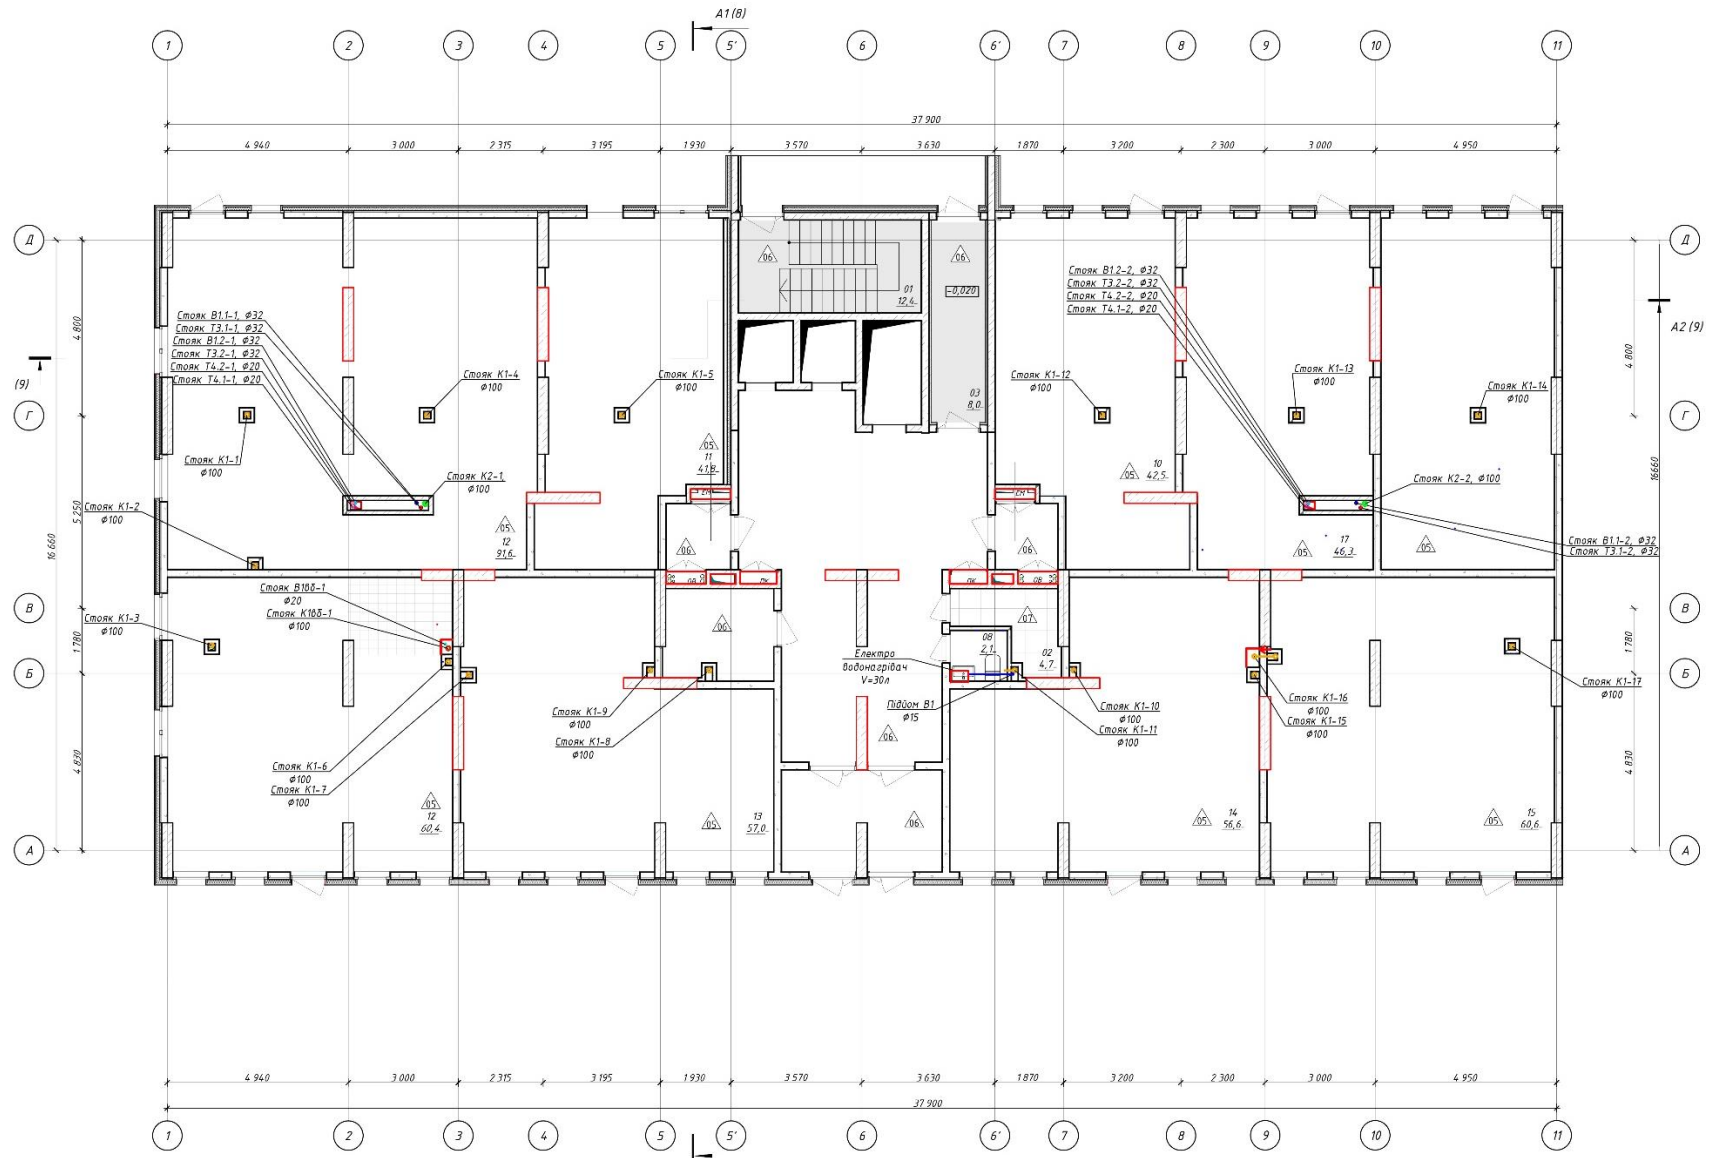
План 1-го поверху під час реконструкції залізобетонної споруди під багатфункціональний комплекс
